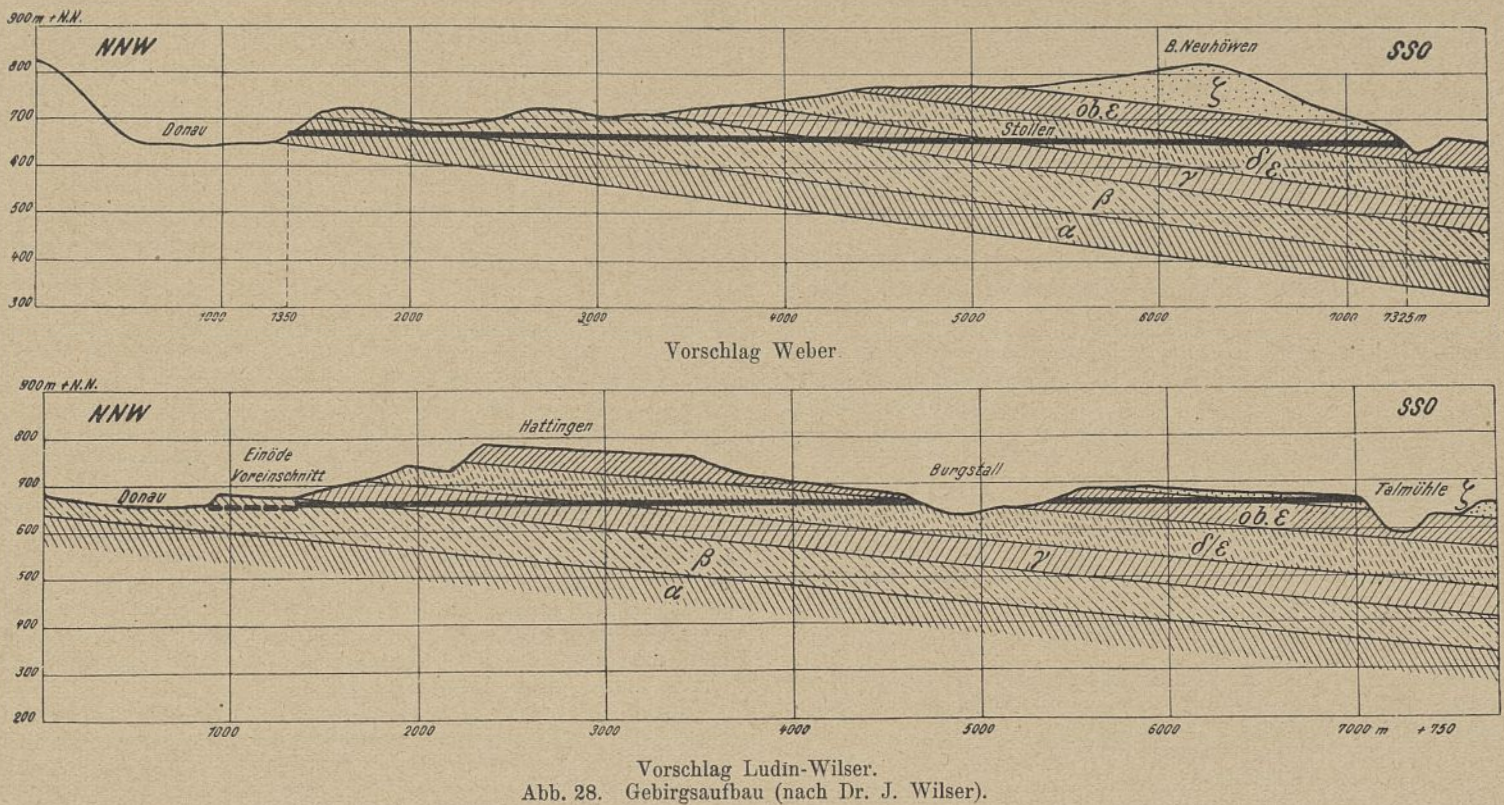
Gebirgsaufbau (nach Dr. J. Wilser).
